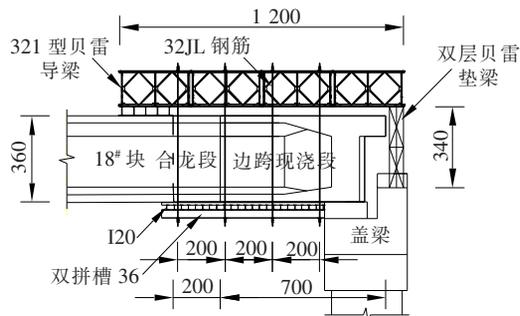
现浇段和合龙段整体施工吊架布置示意图(单位:cm)
